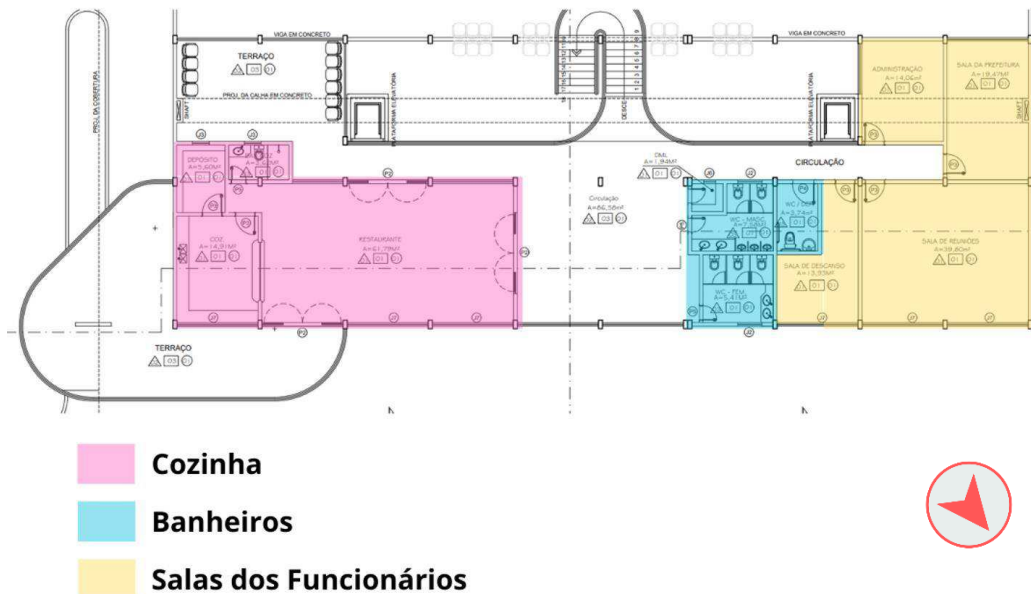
Planta Demolir Construir – Pavimento Térreo
